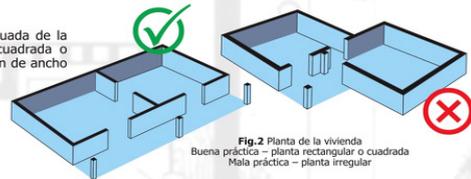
Planta de la vivienda Buena práctica - planta rectangular o cuadrada. Mala práctica - planta irregular
